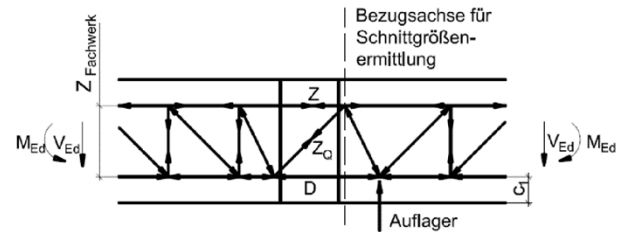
Schöck Isokorb® Typ K, K-F (Variante mehrteilig), mit Druckelementen aus Stahl
